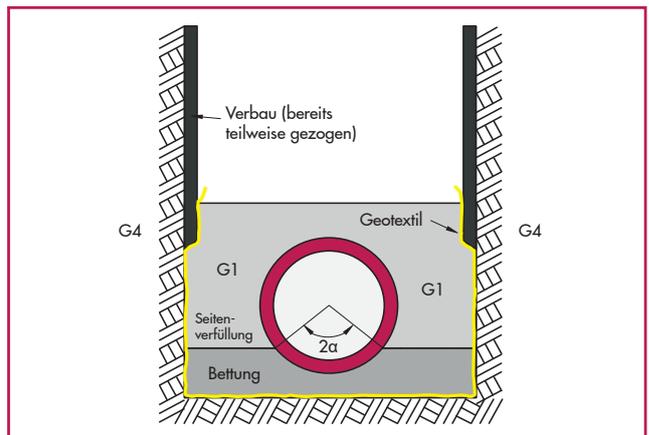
Schutz gegen Ausspülen des Auflagers und des anstehenden Bodens durch Geotextil
